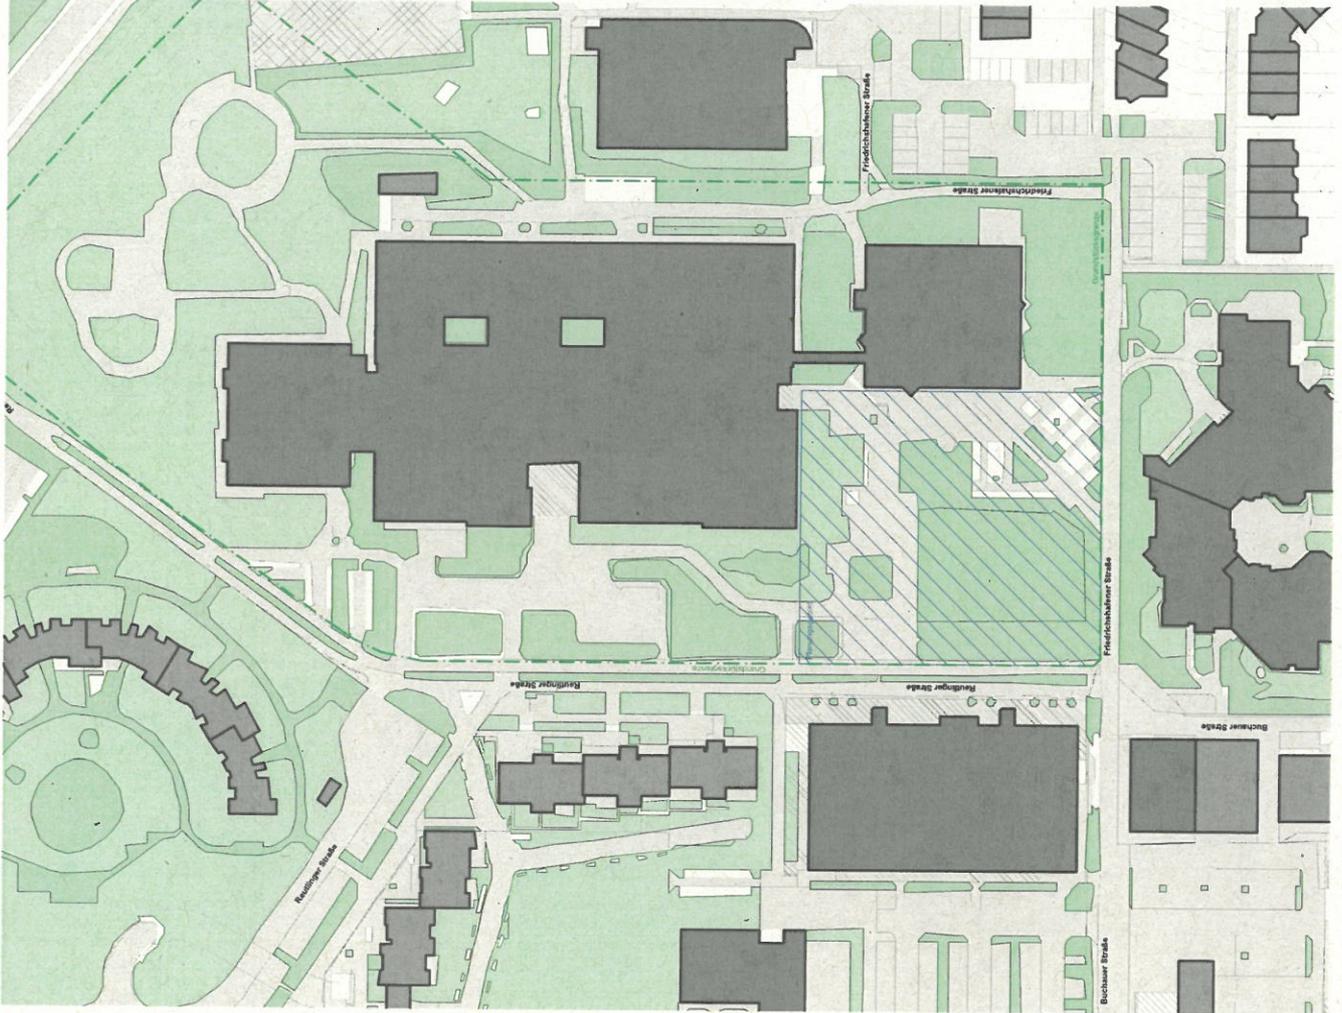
Lageplan des Schulzentrums mit Planungsgebiet
